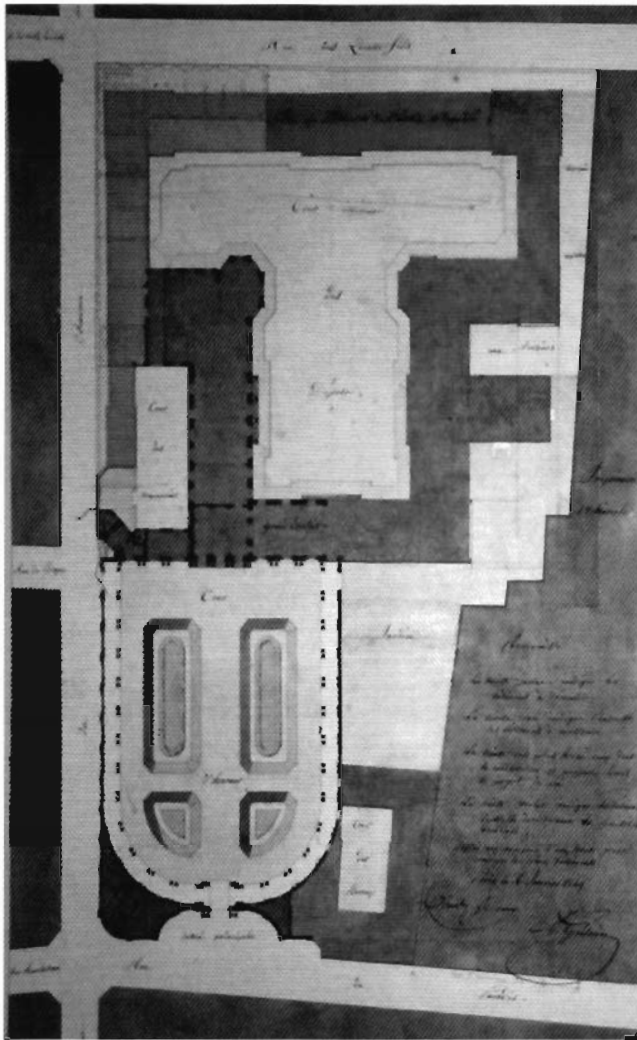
Plan général des bâtiments signé par Charles Lelong et A. Grélerin le 6 janvier 1849, coloré pour plus de lisibilité: en jaune, bâtiments à démolir; en rose, à construire; en rose foncé, construction proposée dans le projet du roi; partie de bâtiment dont l'exécution est demandée; en gris, les vieux bâtiments; en violet-bleu, les constructions bientôt achevées, dont les dépôts dits Louis Philippe qui font pendant à l'hôtel de Soubise dans la cour des dépôts (Archives nationales, ABVB7, *plan d'un projet concernant l'agrandissement des bâtiments des Archives Nationales*).
